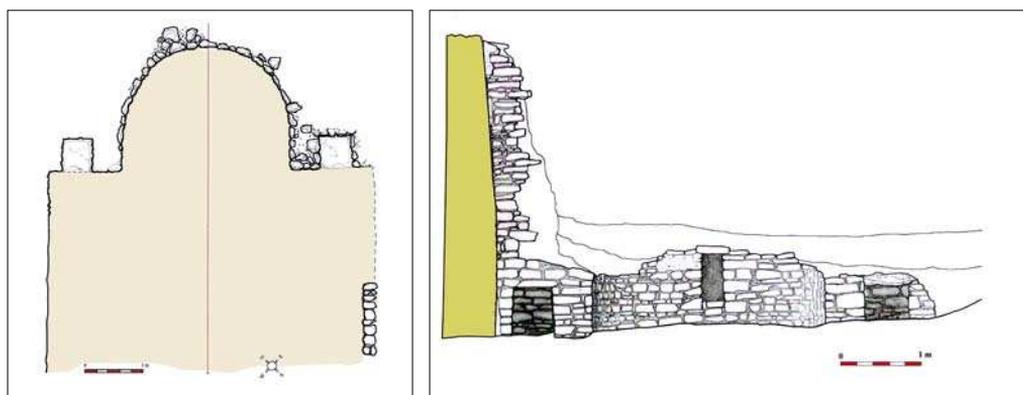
Pianta e sezione della parte settentrionale di Santa Maria di Boikos (E. Canzonieri).
